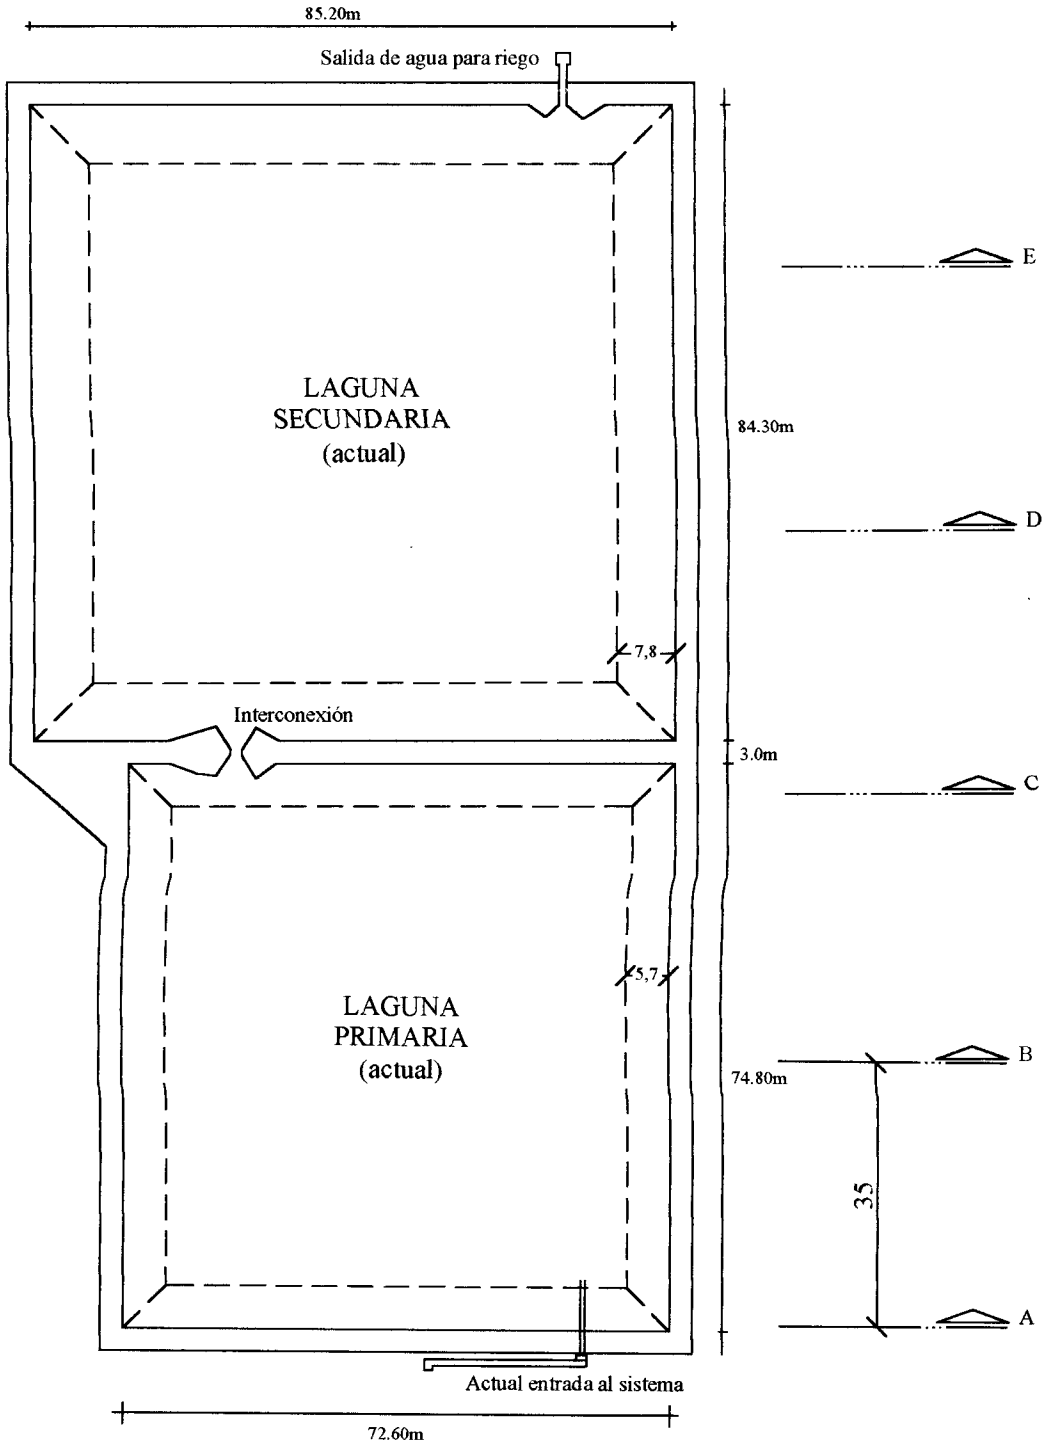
Esquema de llegada de la tubería de ingreso a la laguna primaria.
